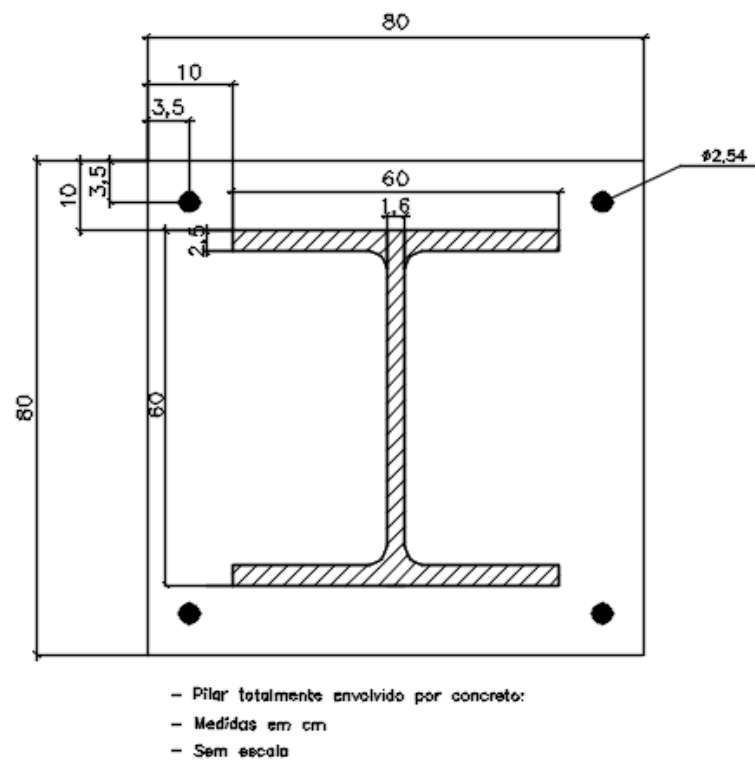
Desenho esquemático – Pilar totalmente envolvido por concreto
